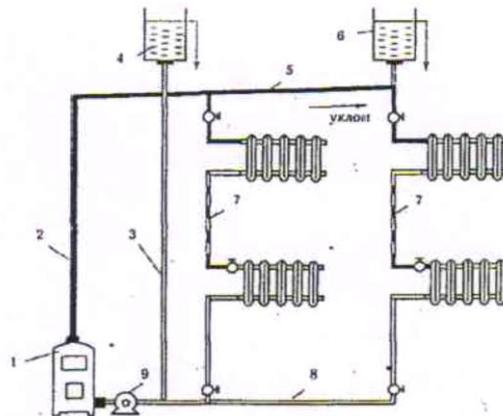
Однотрубный циркуляционный контур: 1 - котёл; 2 - главный стояк; 3 - расширительная труба; 4 - расширительный бак; 5 - верхняя разводка; 6 -воздухосборник; 7 - обратные стояки; 8 - обратная линия; 9 - насос.
